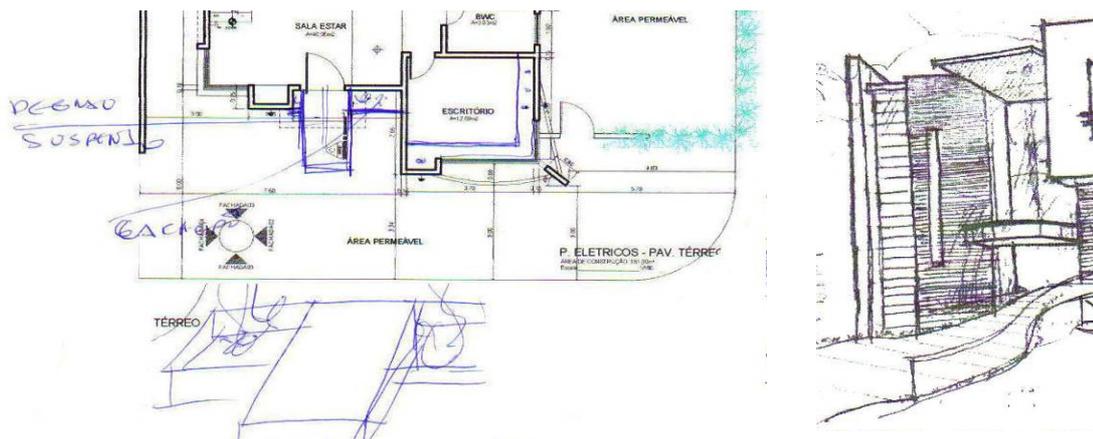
Parte da planta baixa do pavimento térreo e perspectiva (focando no detalhe do acesso principal)
